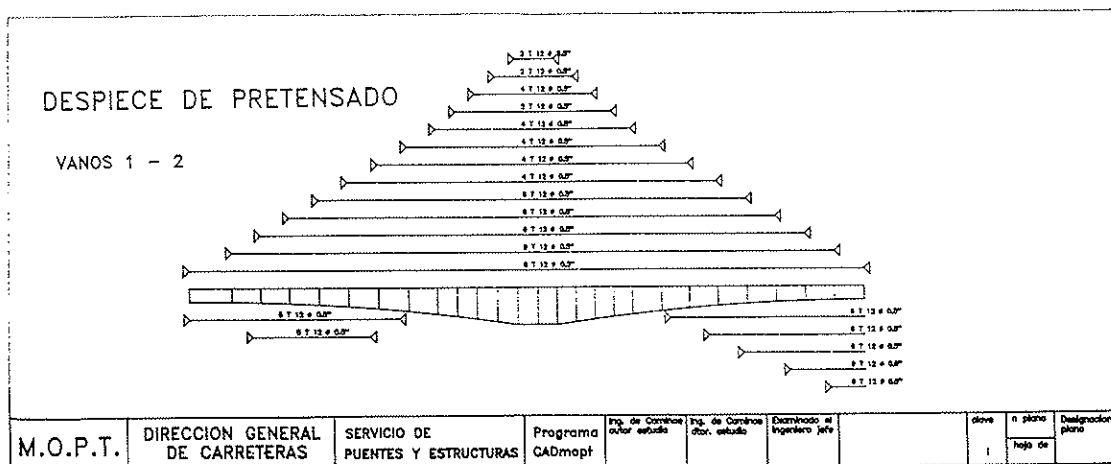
Puente ejemplo. Plano de despiece del pretensado.
